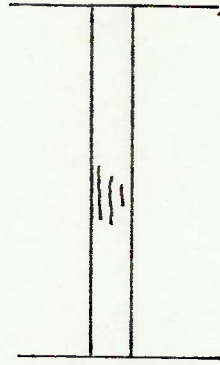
Fissuras verticais no pilar indicando insuficiência de estribos .
